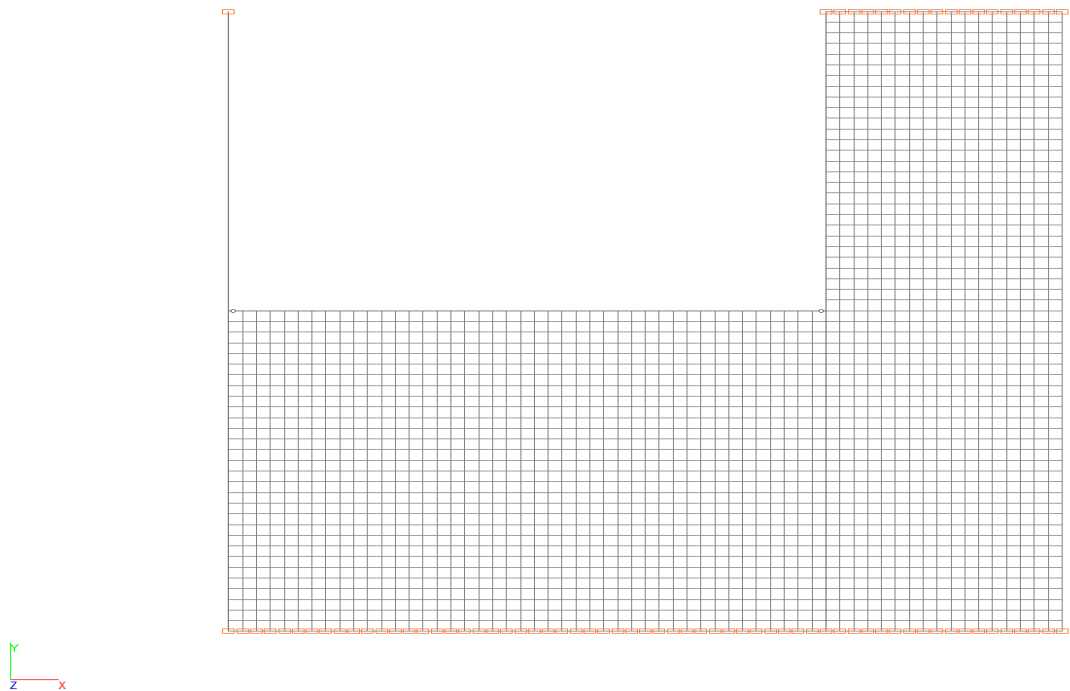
Расчётная схема плиты перекрытия в плоскости
